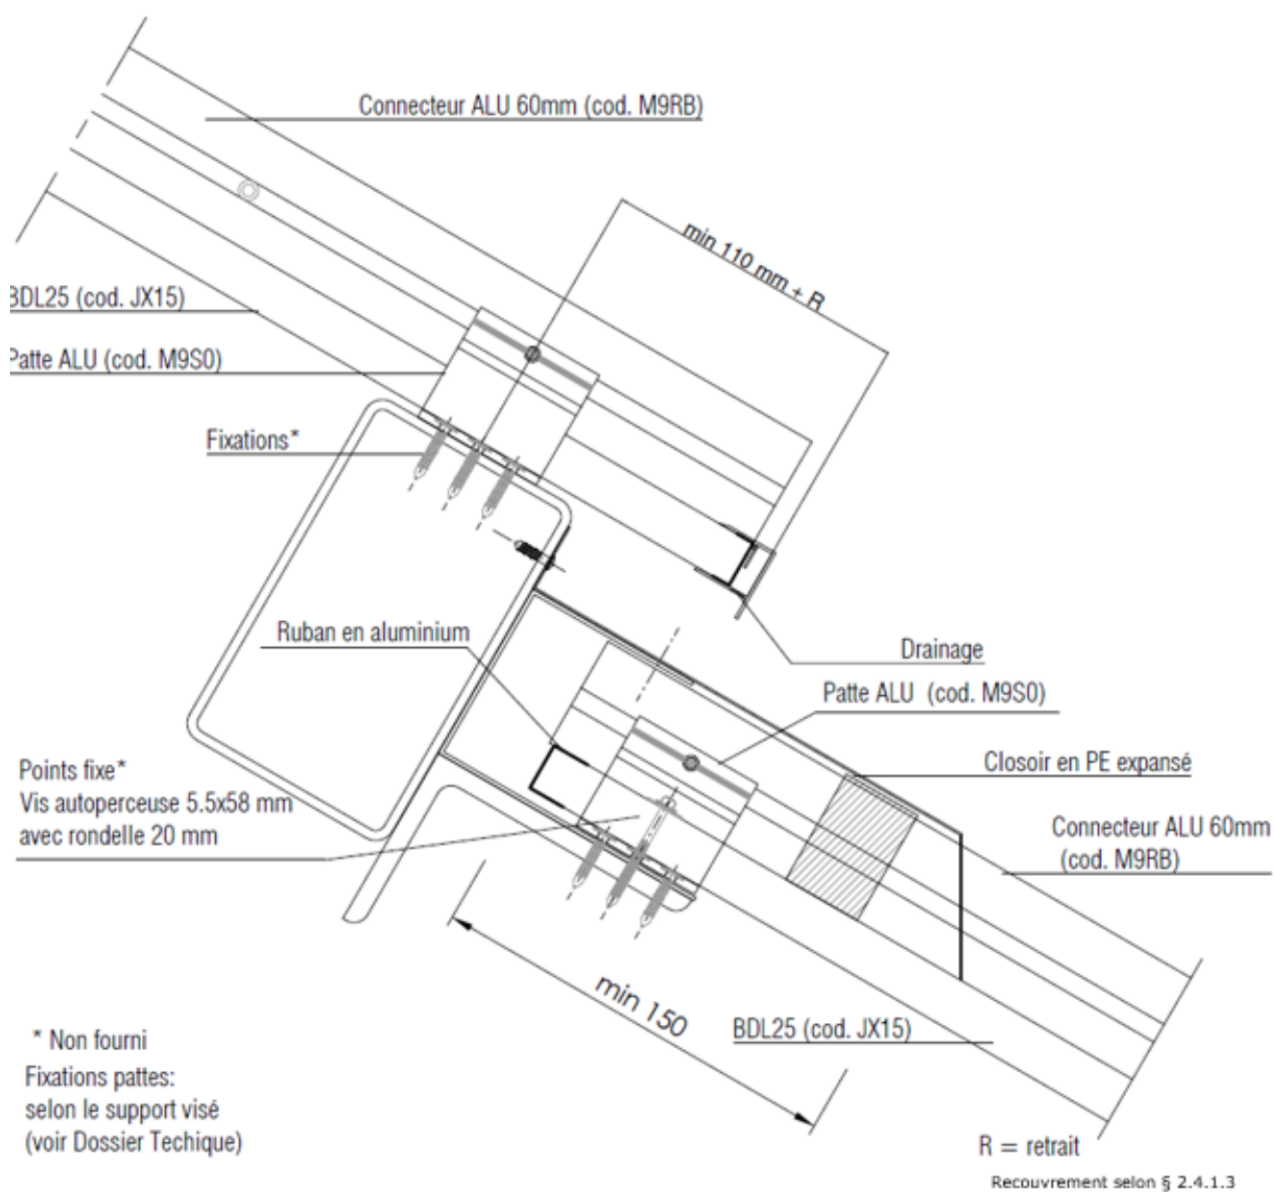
Ressaut avec point fixe haut et connecteur M9RB
